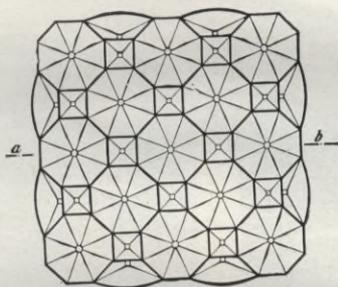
Grundriß eines Silos mit achteckigen Zellen.
